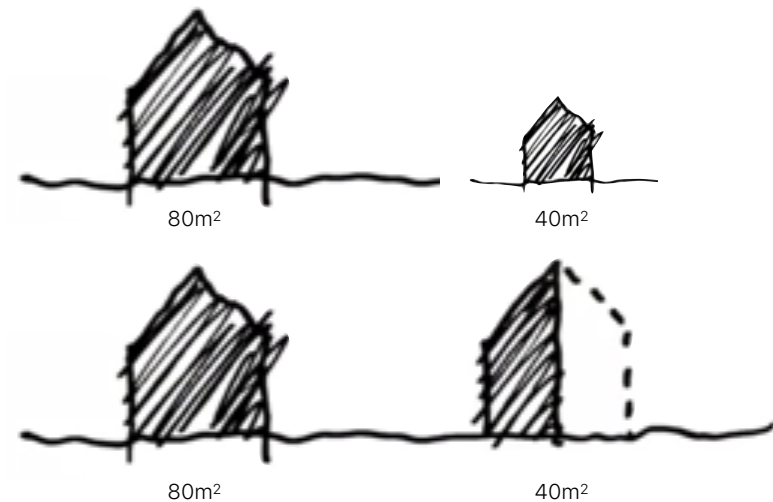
Esquema vivienda ampliable; Alejandro Aravena
